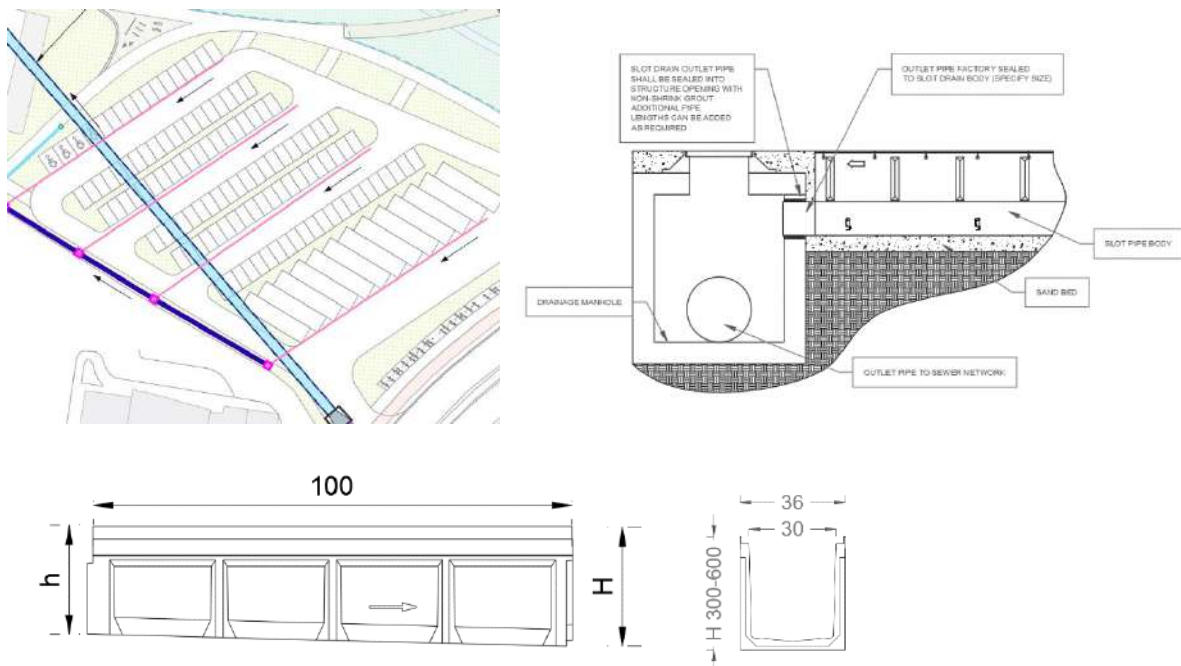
Zona e Parkimit dhe kanalet drenazhuese
